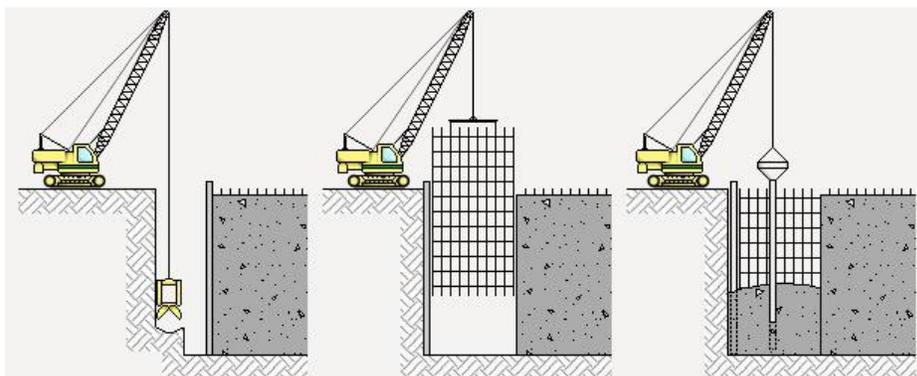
CONSTRUCCIÓN DE MUROS PANTALLA SOTANOS Y ESTRUCTURAS PROFUNDAS
